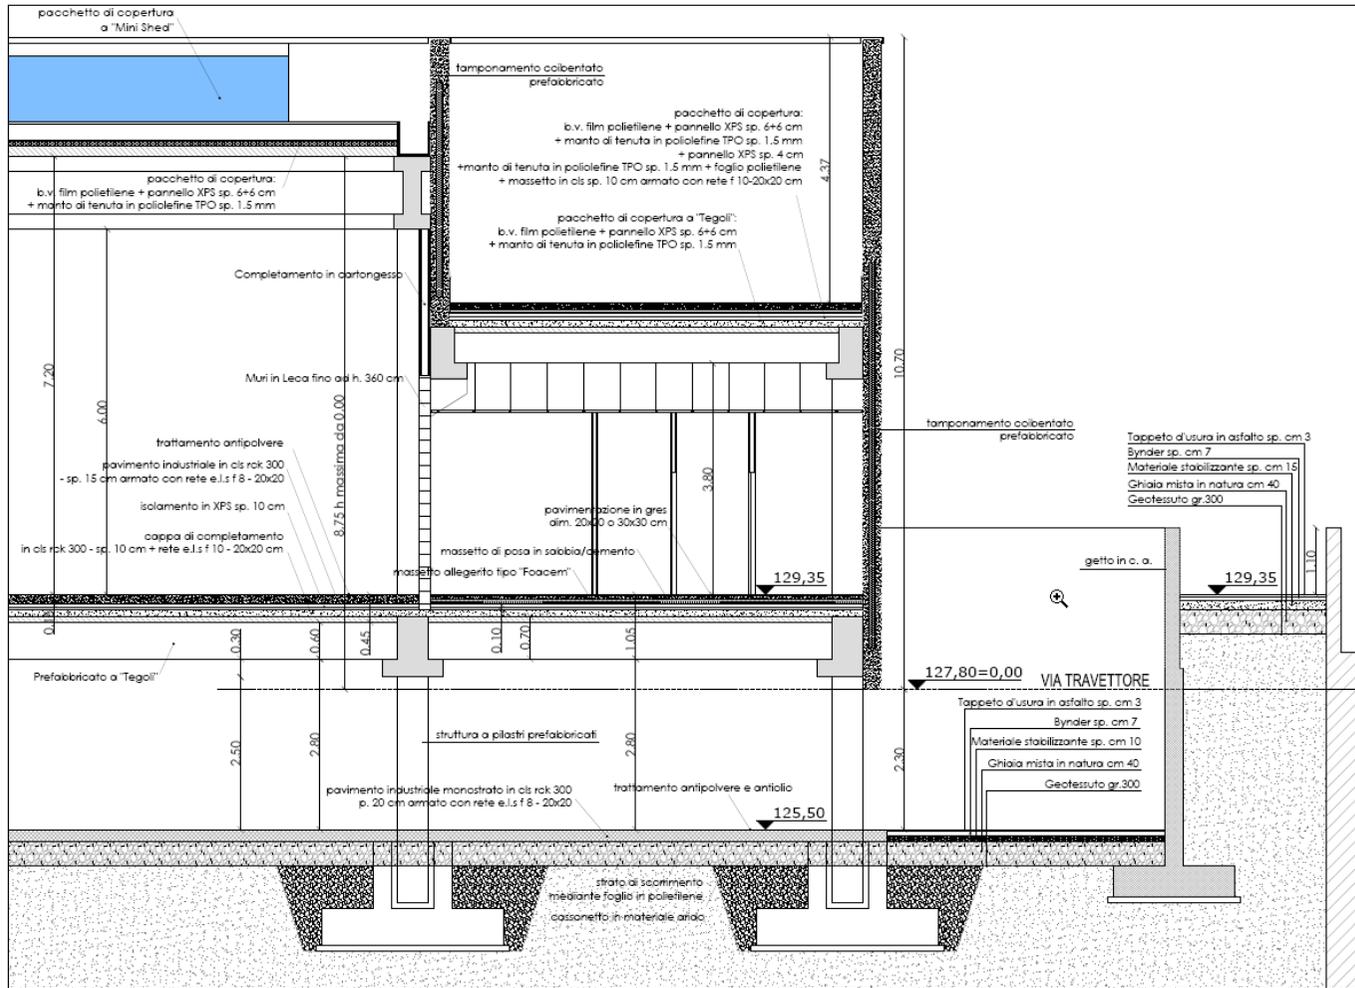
Sezione Est - Ovest (Variante approvata - Tavola 3b)
